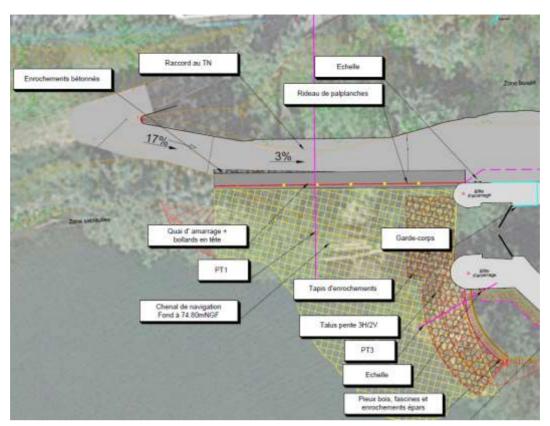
Extrait de la vue en plan du quai d'amarrage amont
